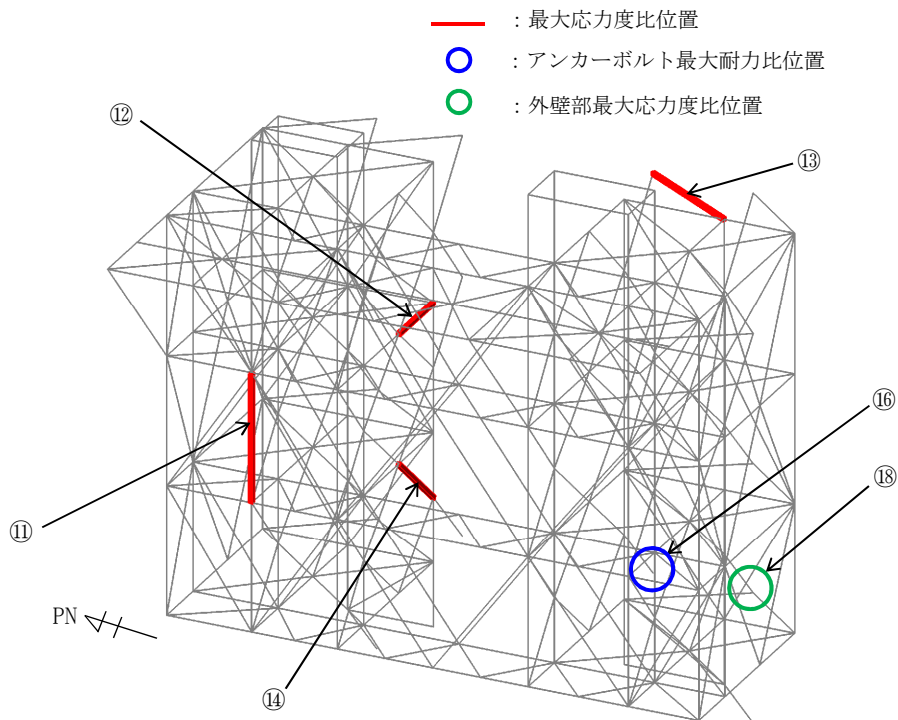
(2) 最大応力度比位置図(燃料取扱設備支持部, 1/2Ss450 地震時)
